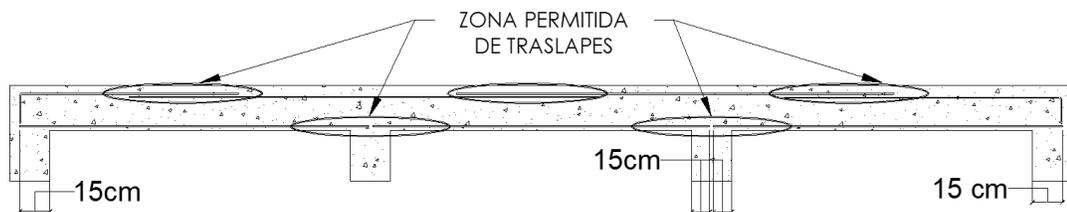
Colocación de acero de refuerzo en losa densa según caso 1
